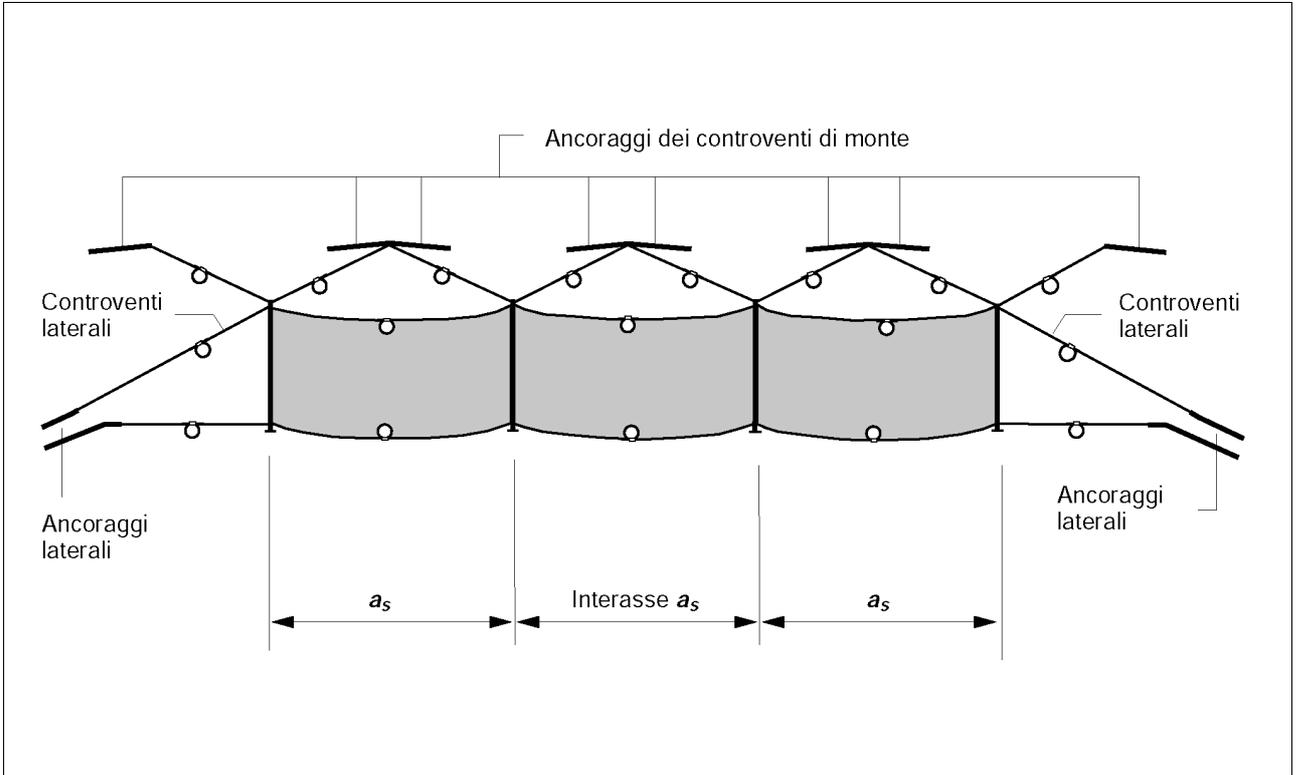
Vista frontale di una rete di protezione ancorata a monte con descrizione degli elementi portanti.
